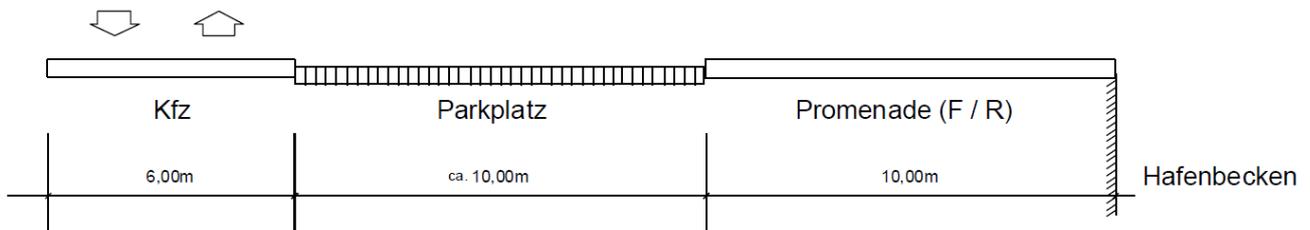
Querschnitt Planstraße A - Parkplätze – öffentliche Promenade
